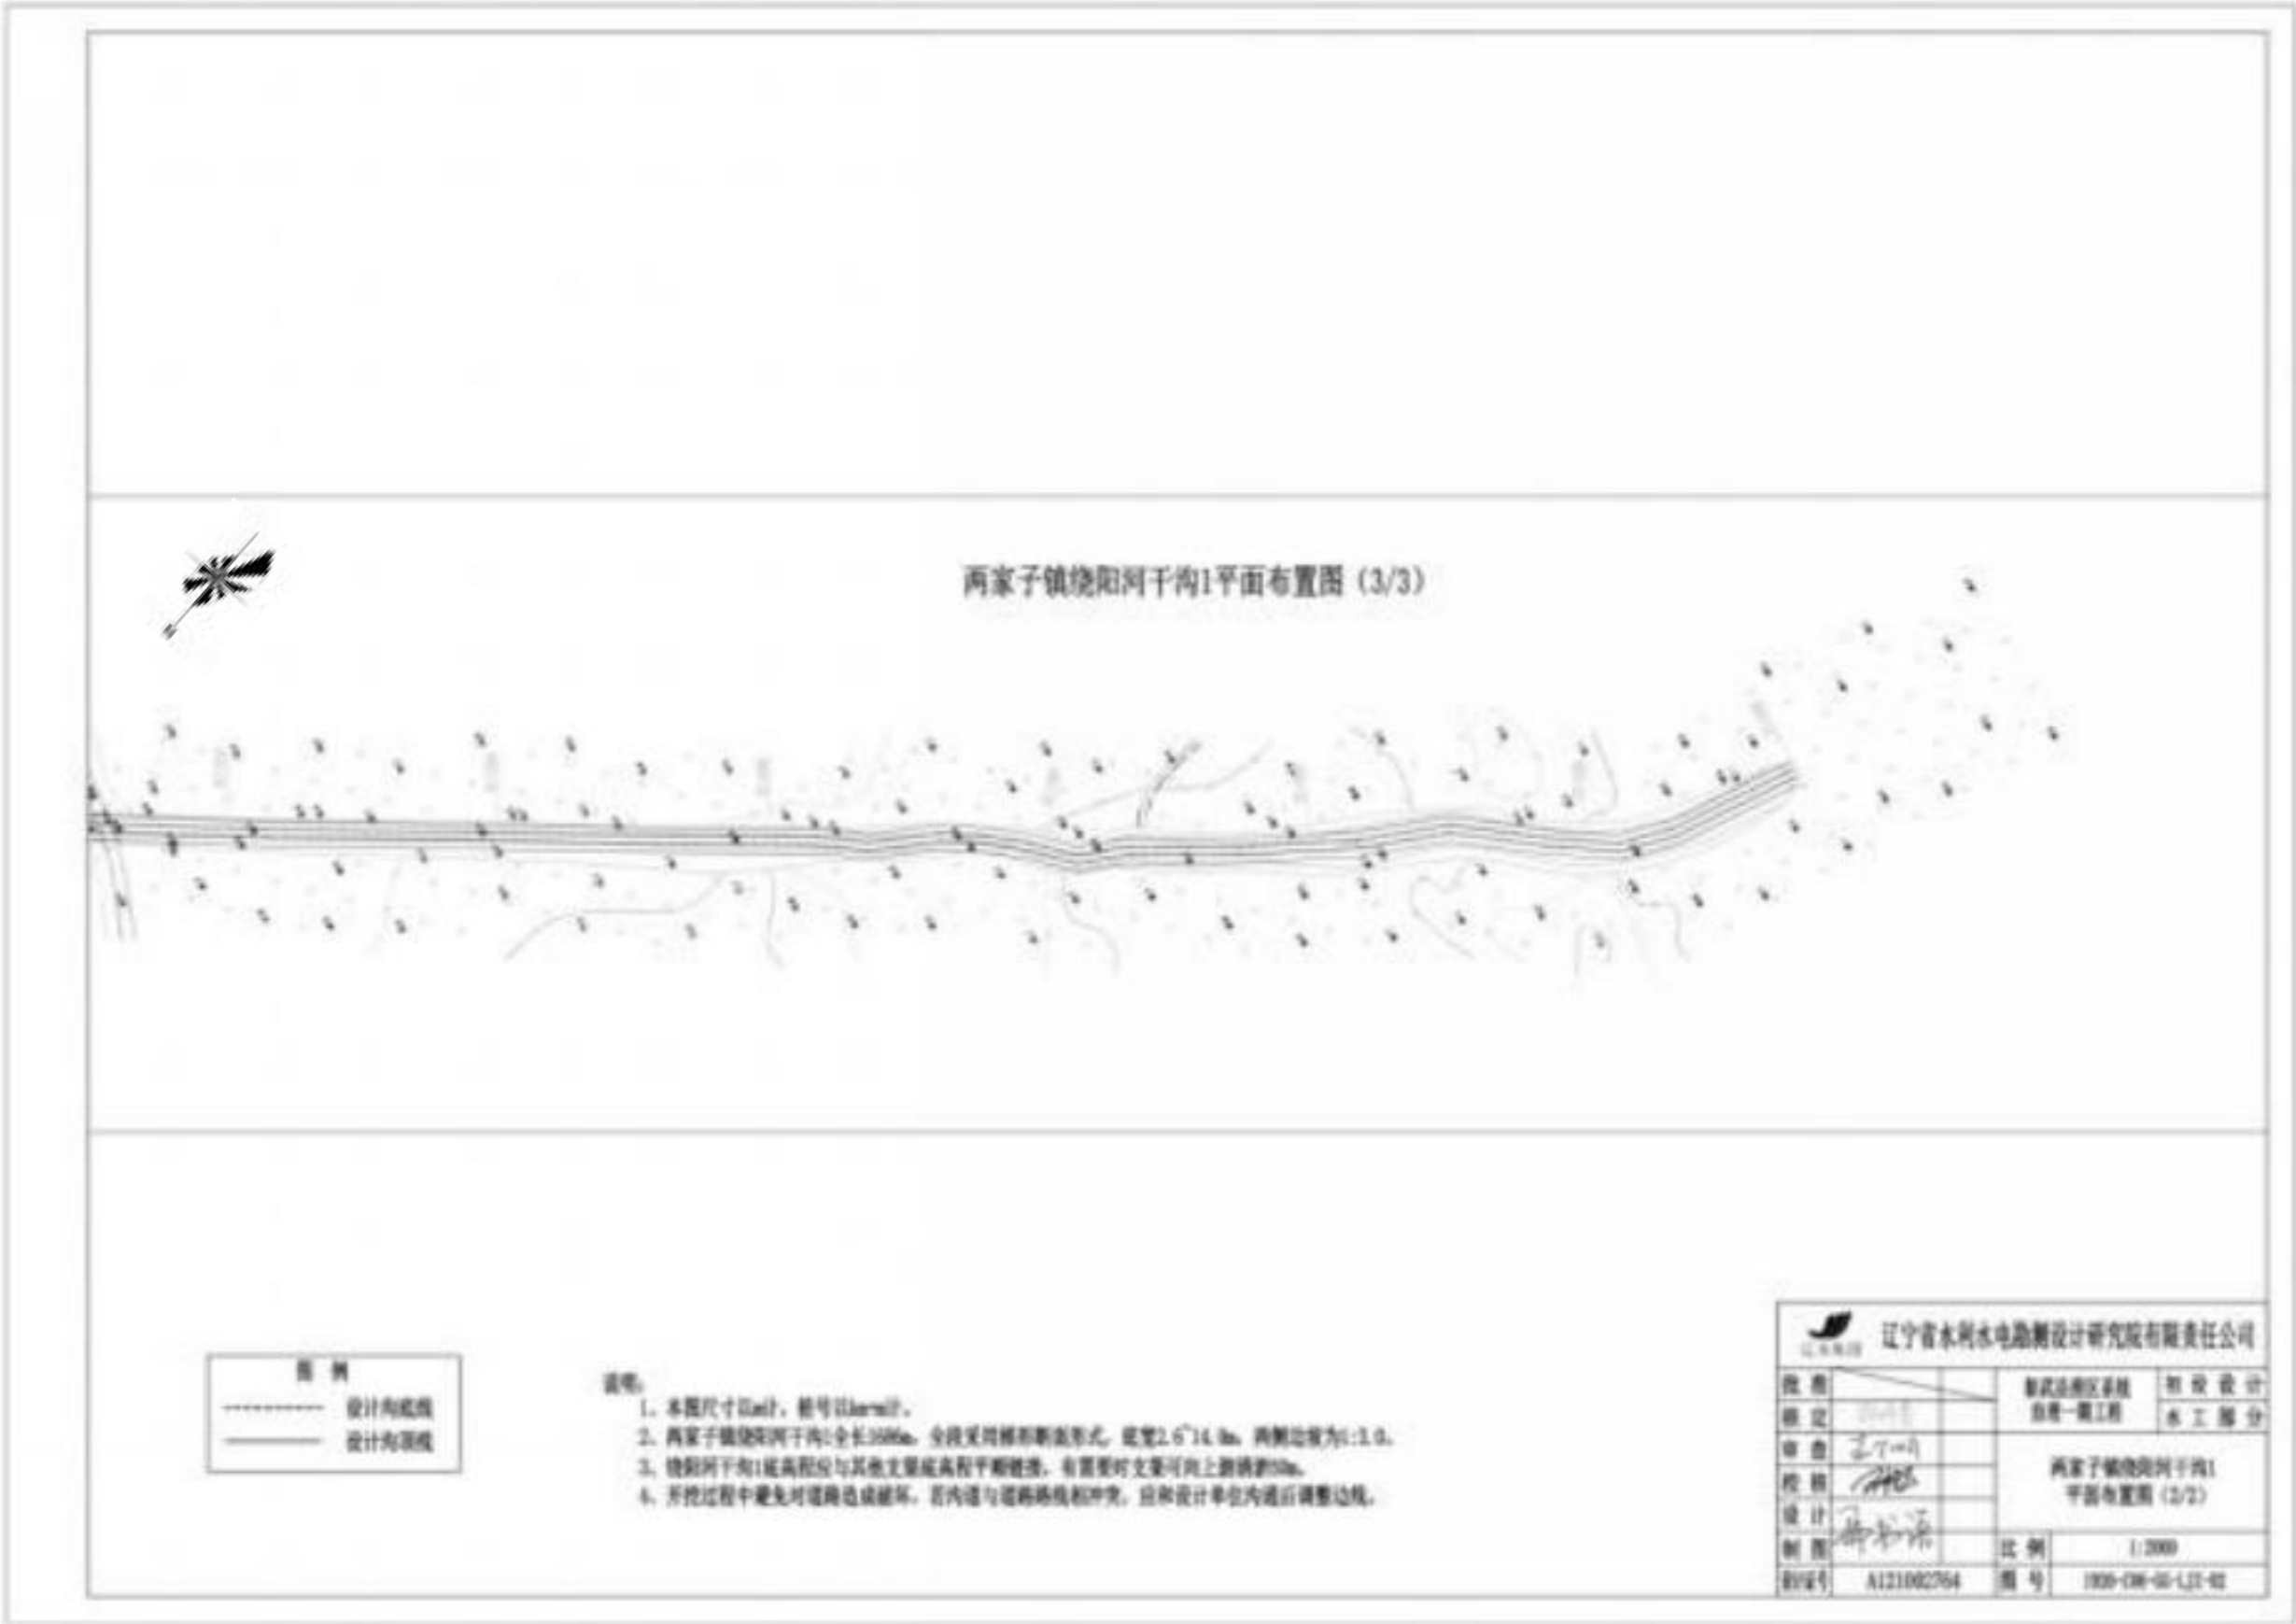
(2) 两家子镇绕阳河干沟 1 平面布置图
